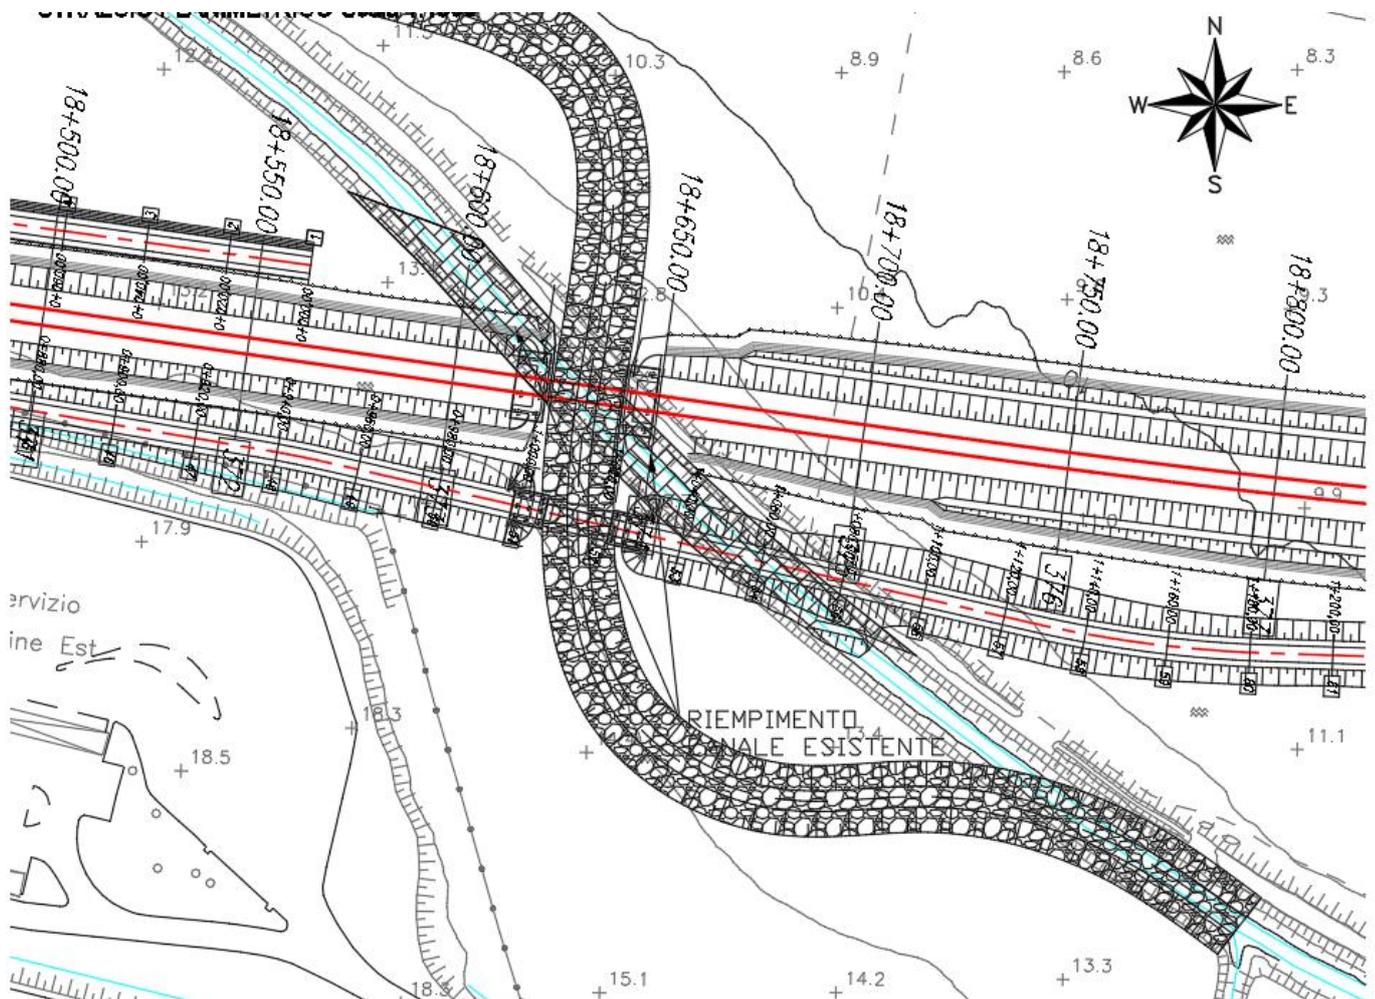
Stralcio planimetrico – ubicazione opera d’arte
